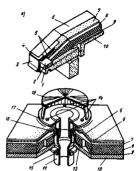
Конструкции отвода воды с покрытий промышленных зданий:
